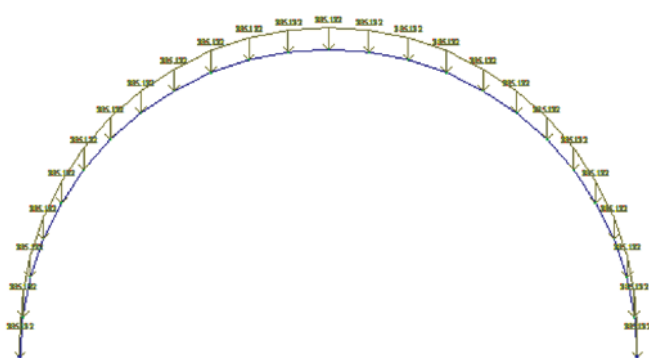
Схема приложения нагрузки от собственного веса монолитной железобетонной обделки
